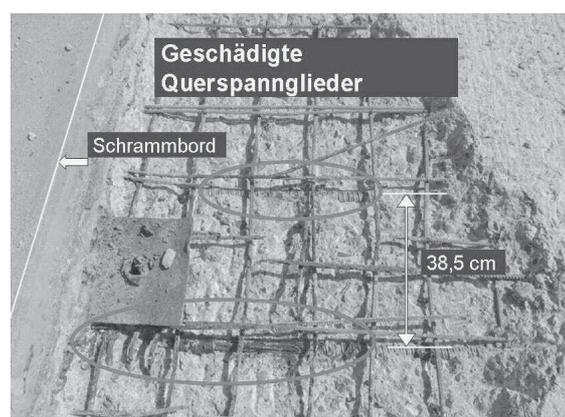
Schadensausschnitt nach Entfernen der Bauwerksabdichtung. Fahrbahnplattenoberseite mit teilweise gerissenen Querspanngliedern (rot umrandet) im Bereich eines Einbauteils
